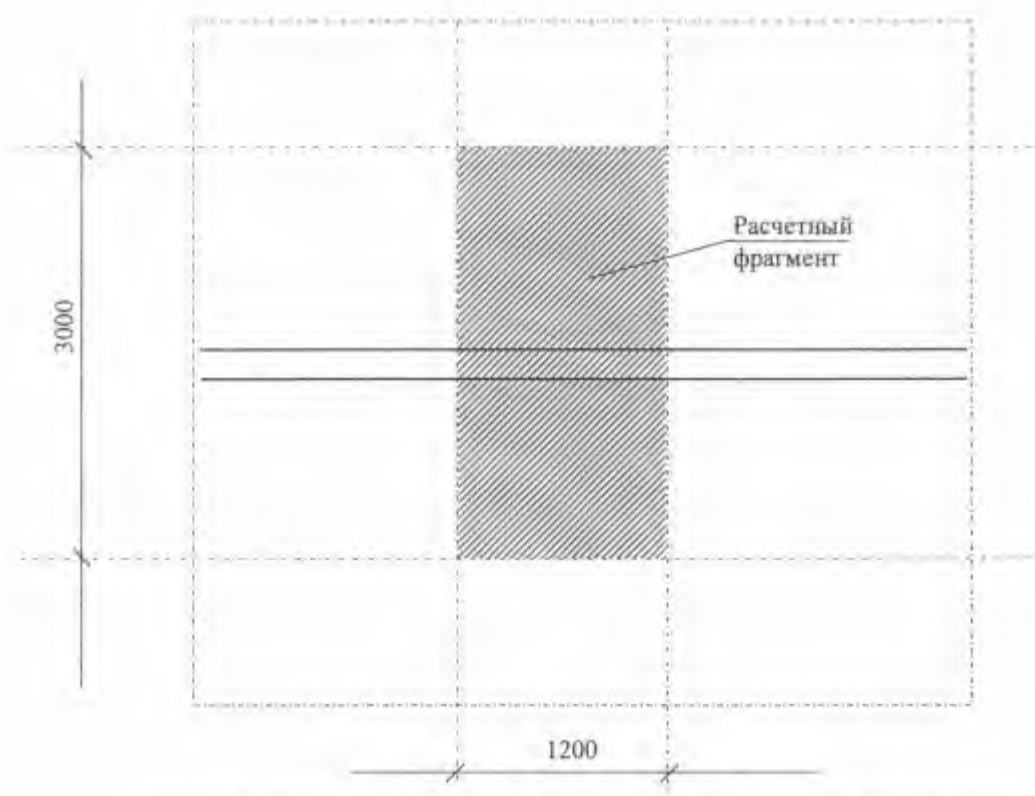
Расчетная схема фрагмента наружной стены здания для определения приведенного сопротивления теплопередаче участка без проемов (вид со стороны помещения)
